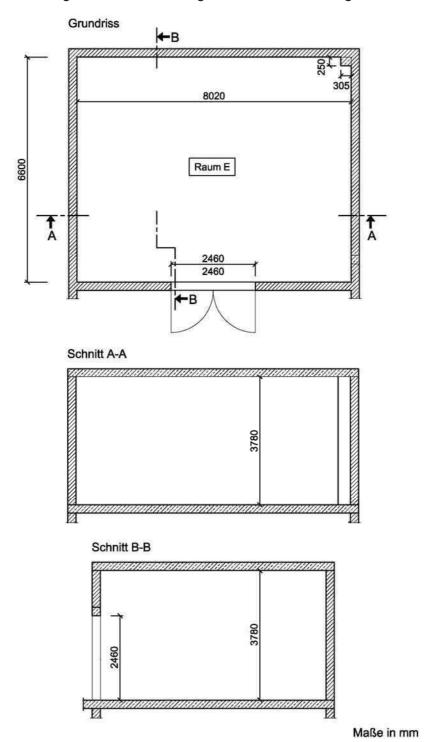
Grundriss und Schnitte des Hallraums.
